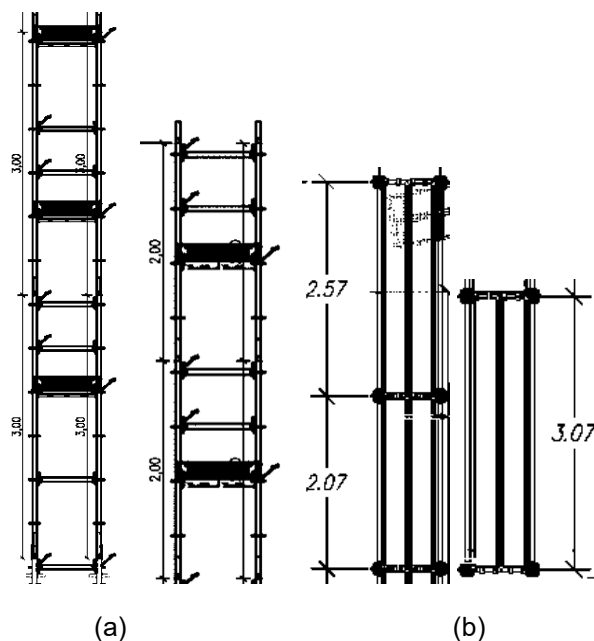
Alturas e comprimentos dos andaimes: (a) Corte transversal (b) Planta
